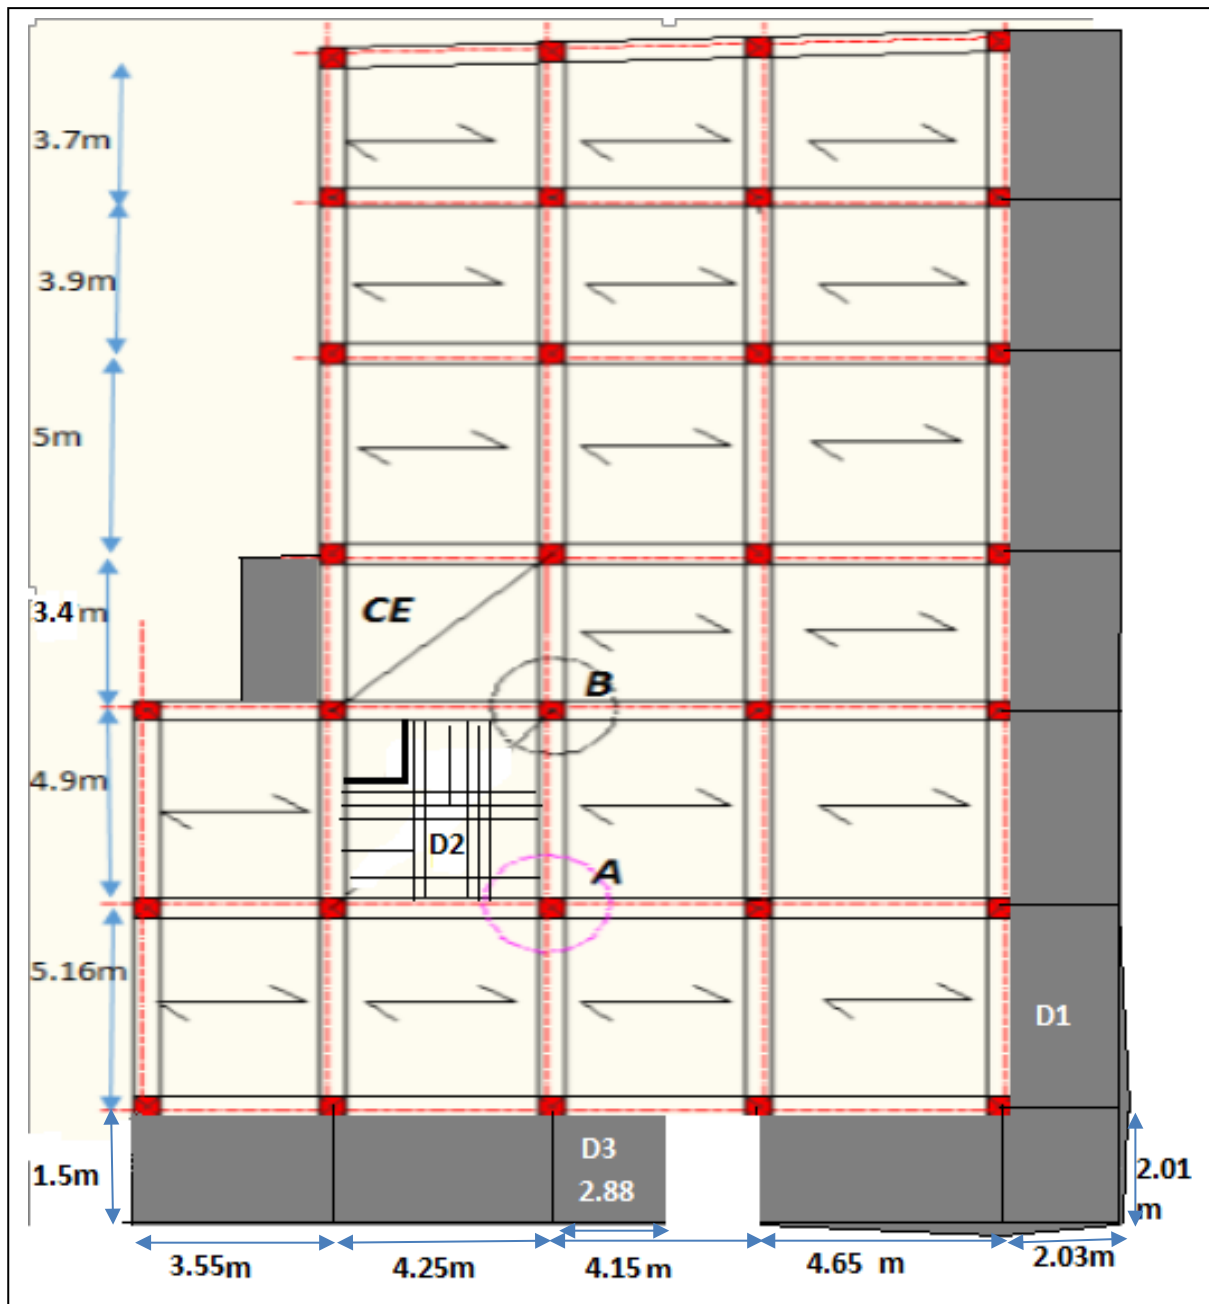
Schéma de disposition des poutrelles pour le plancher étage courant
